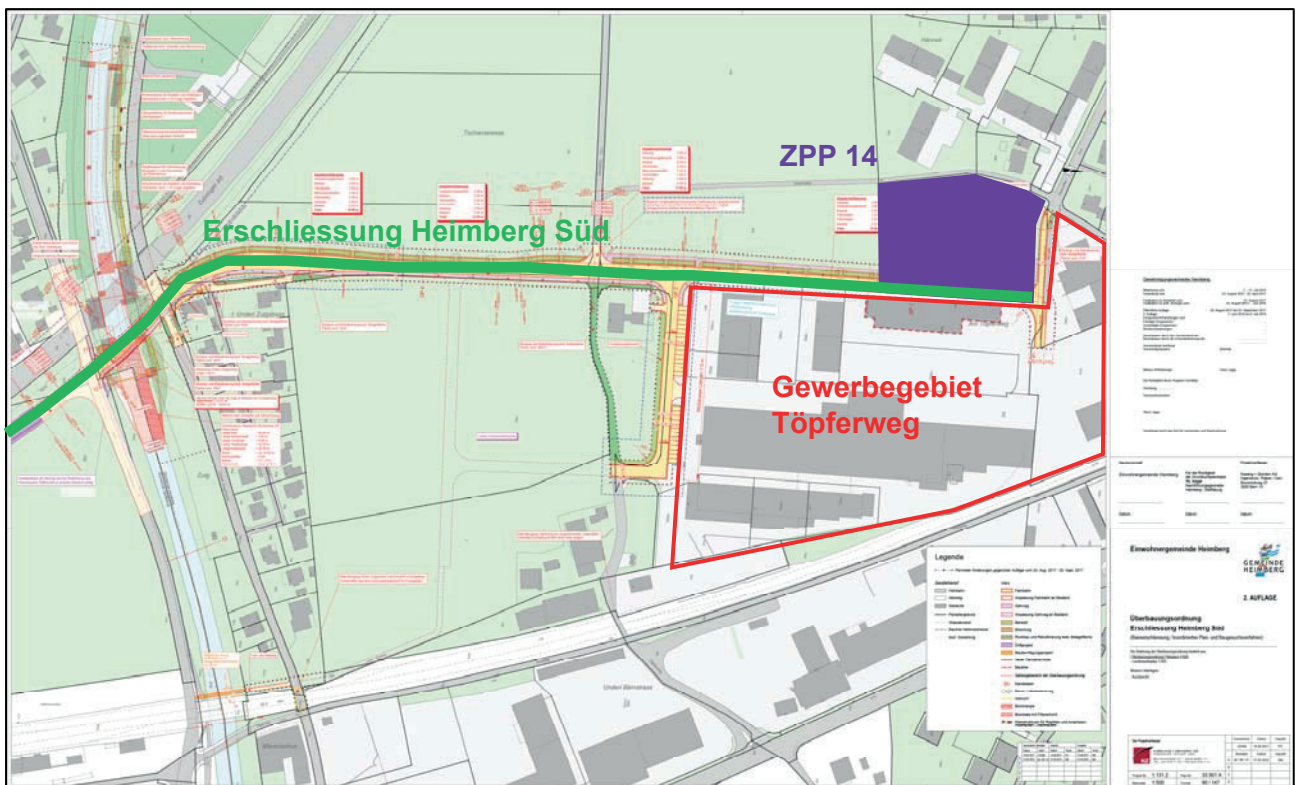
Auszug aus Situationsplan ÜO Erschliessung Heimberg Süd, unmassstäblich
